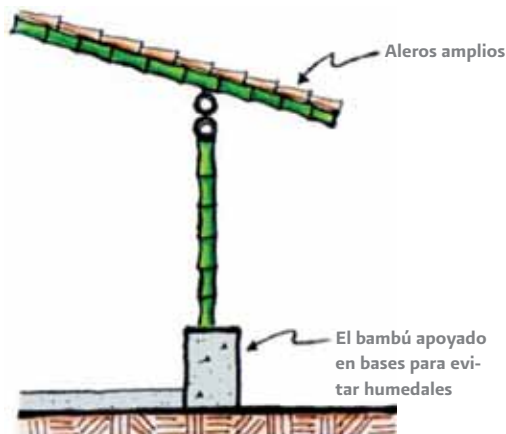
Ejemplo de diseño arquitectónico para proteger las construcciones de bambú.
